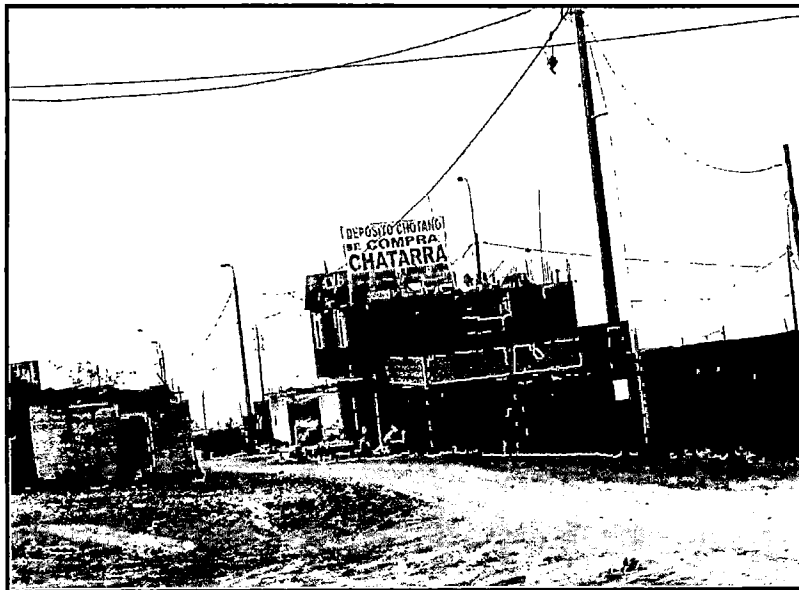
Comercio en el rubro de construcción acero, cemento y casas prefabricadas de madera
